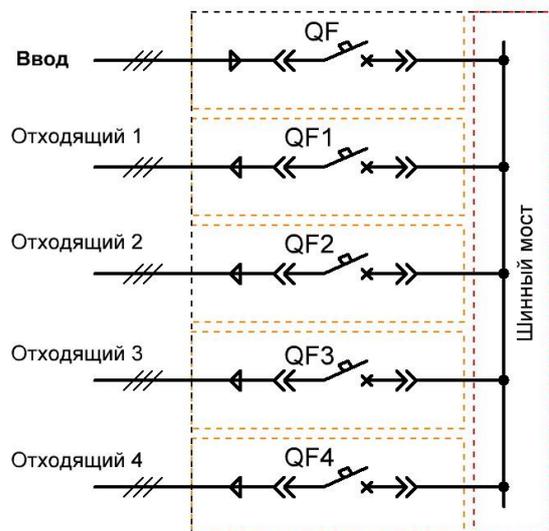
Схема однолинейная ШР-ПП-160...1600А с выдвижными автоматическими выключателями.
